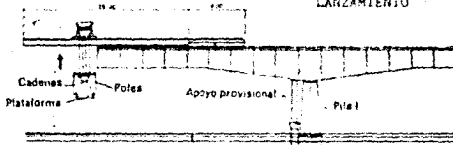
MONTAJE CON VIGA DE LANZAMIENTO
